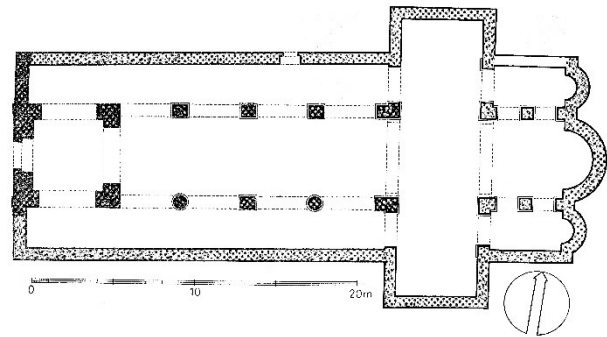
Grundriss der Klosterkirche Herrenbreitungen
